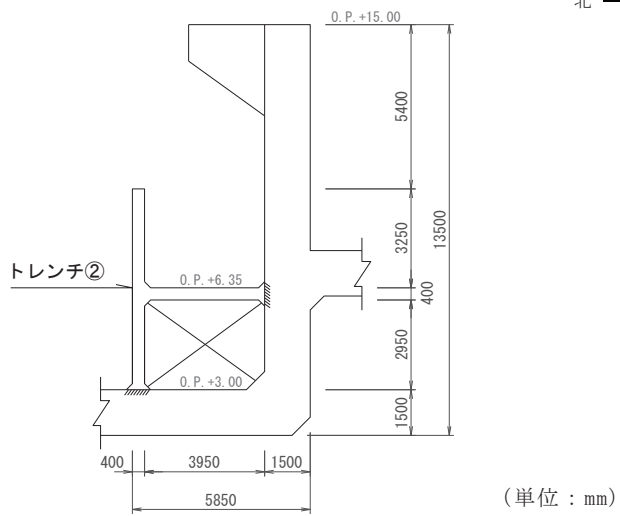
(8) 補機ポンプエリア断面図 (⑧—⑧断面)
